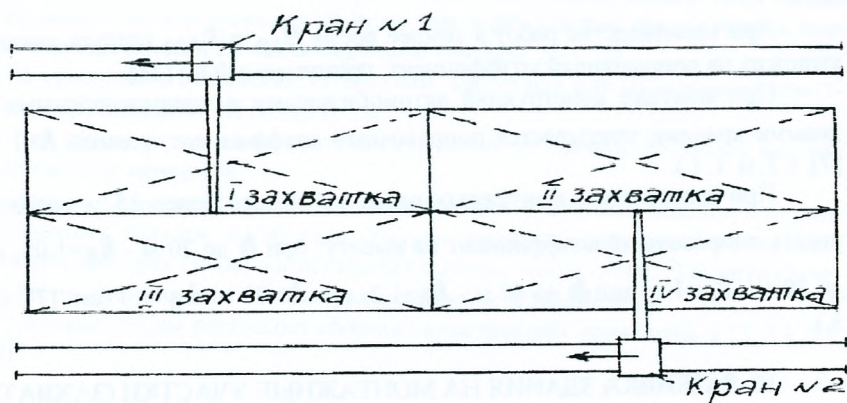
Схема разбивки многоэтажного здания на захватки при монтаже конструкций двумя башенными кранами, располагаемыми с двух сторон здания.
